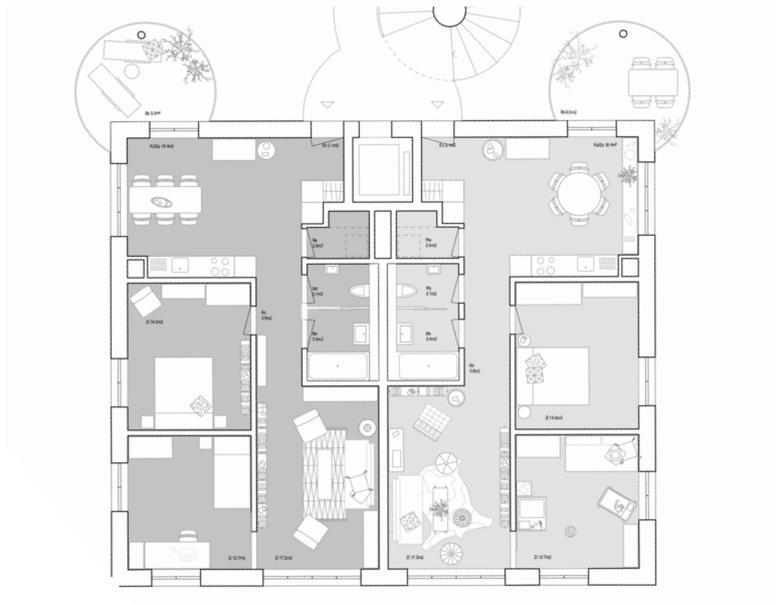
Grundrisse 3.5 Zimmer Wohnung
